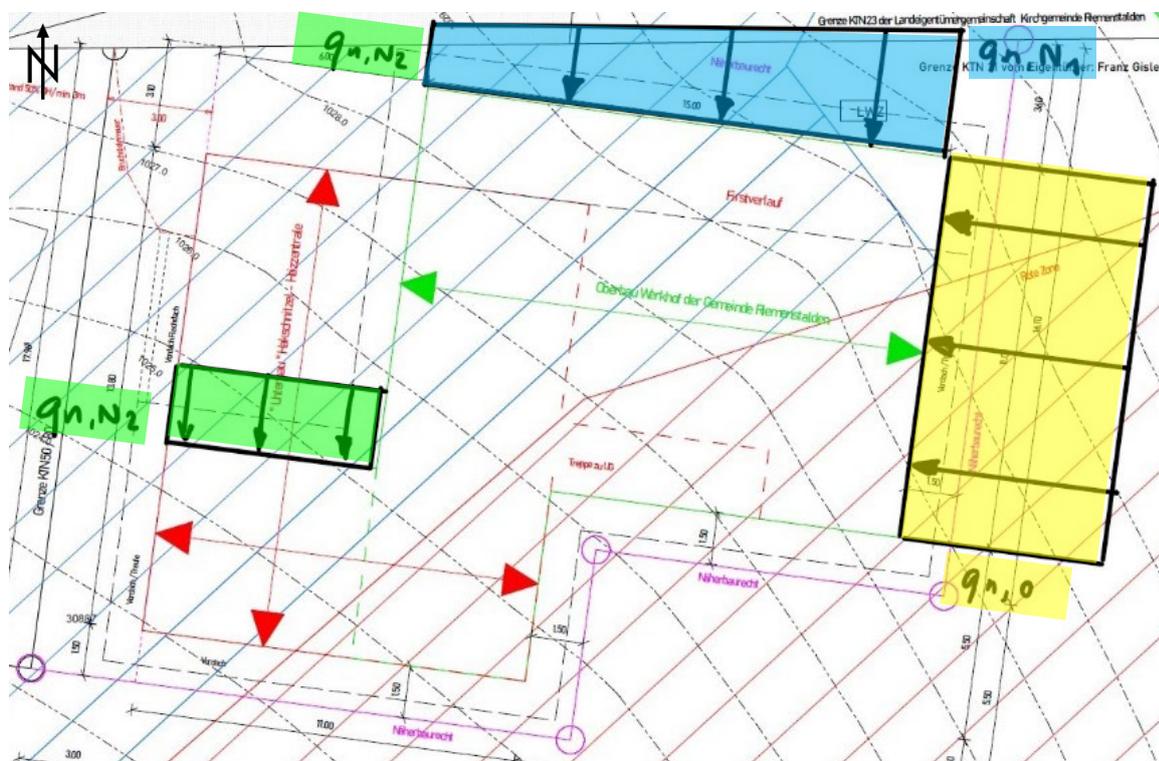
Belastungsschemas im Grundriss. Die Einwirkungen an der Nordfassade nehmen linear von Ost nach West ab.
